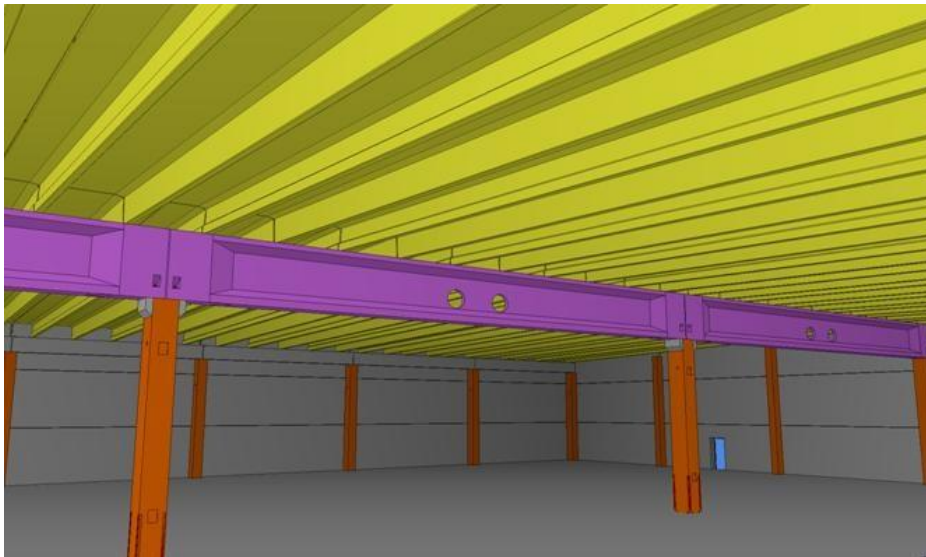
Betonista valmistettuja pilareja (Oivarauta.fi www-sivut).
